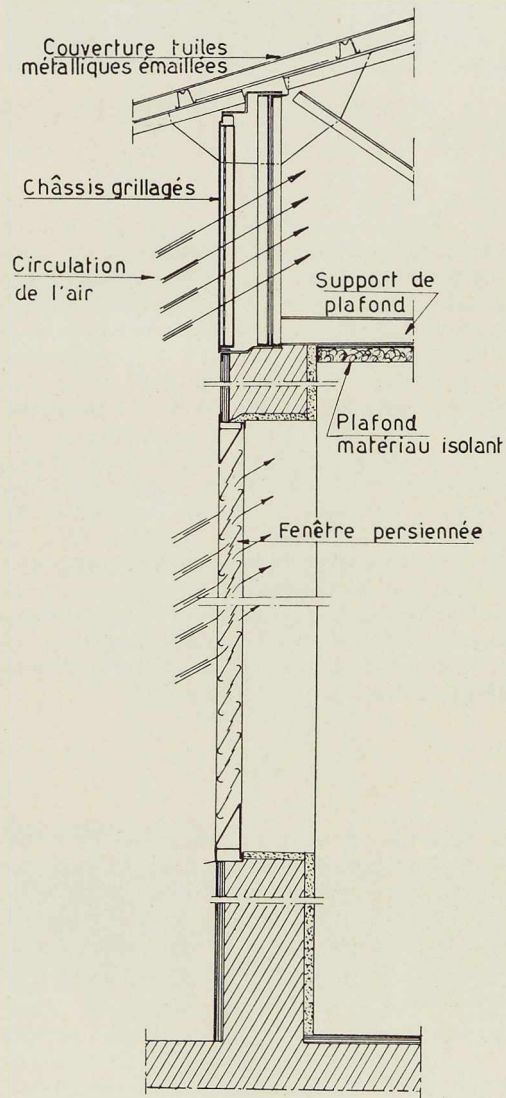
Coupe verticale en façade d'un bungalow type BW 4.
